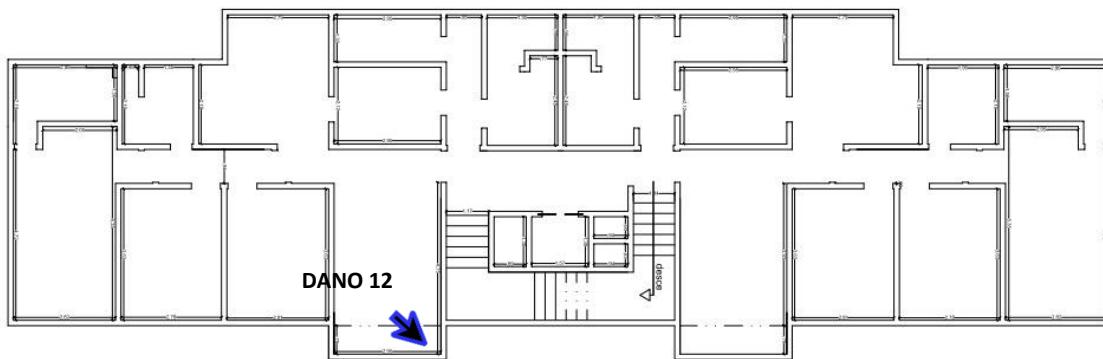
Planta Baixa (croqui) do Pavimento do 3º andar – Bloco A – Cond. Armando Lôbo.
